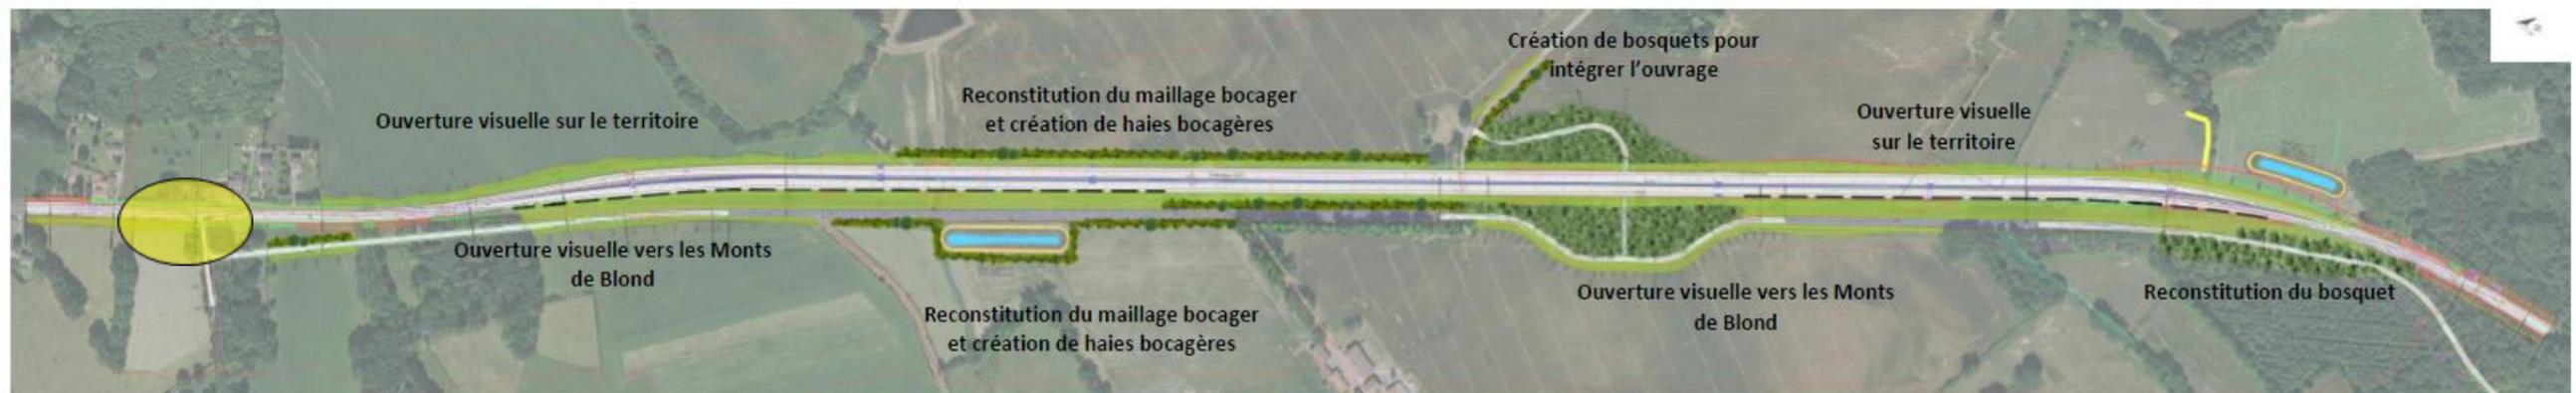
Vue en plan indicative des aménagements paysagers sur la section de Chamborêt
